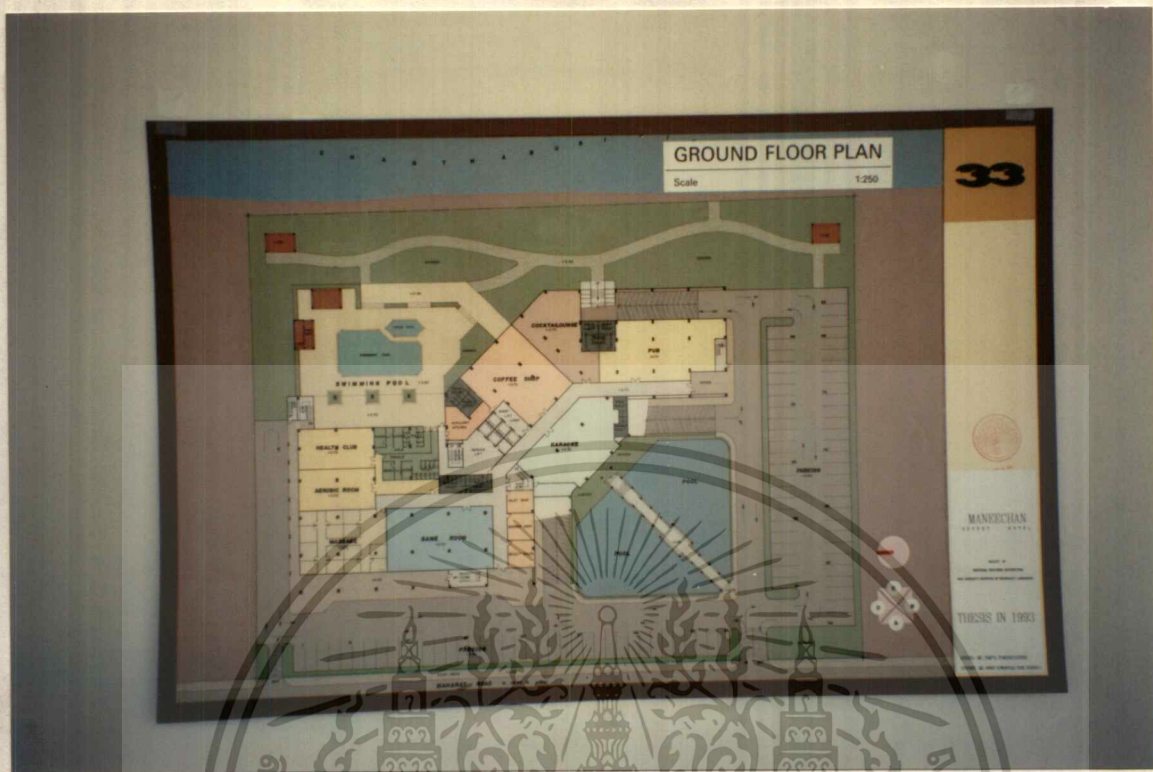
แสดงผังบริเวณของโครงการ
